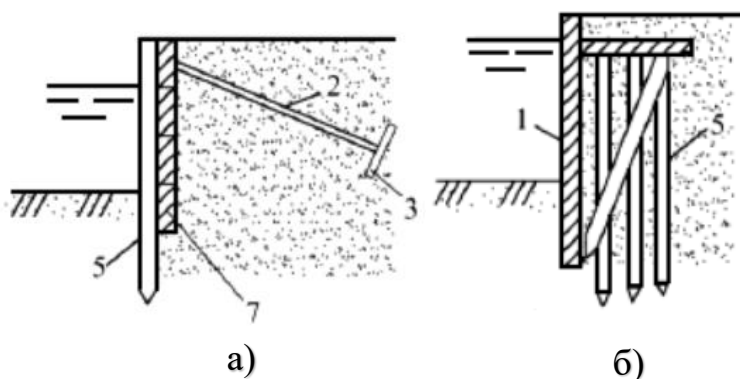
Гибкие: а – забирчатого типа, б - свайный ростверк с передним шпунтом: 1 – шпунт; 2 – анкерная тяга; 3 – анкерная плита; 4 – анкерные сваи; 5 – сваи; 6 – жесткий анкер; 7 – забирка.
